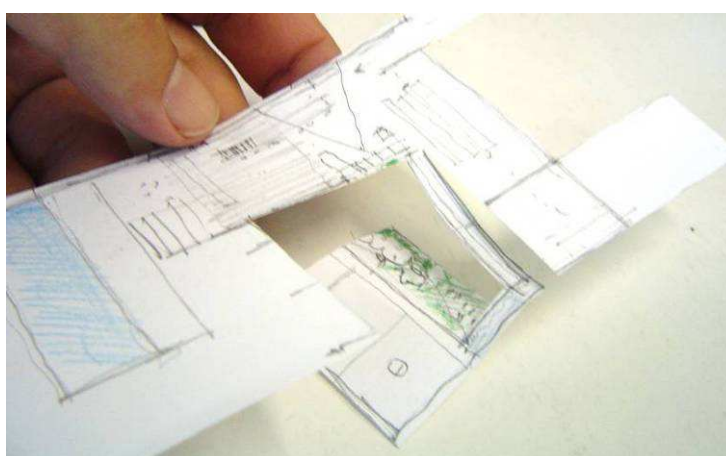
Desenvolvimento da planta central da FIG. 27, sem rampa
